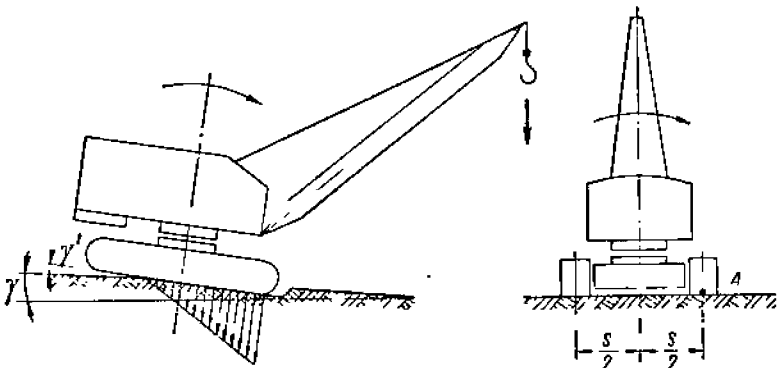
Расчетная схема устойчивости гусеничного крана. А — расчетное ребро опрокидывания поперек пути
